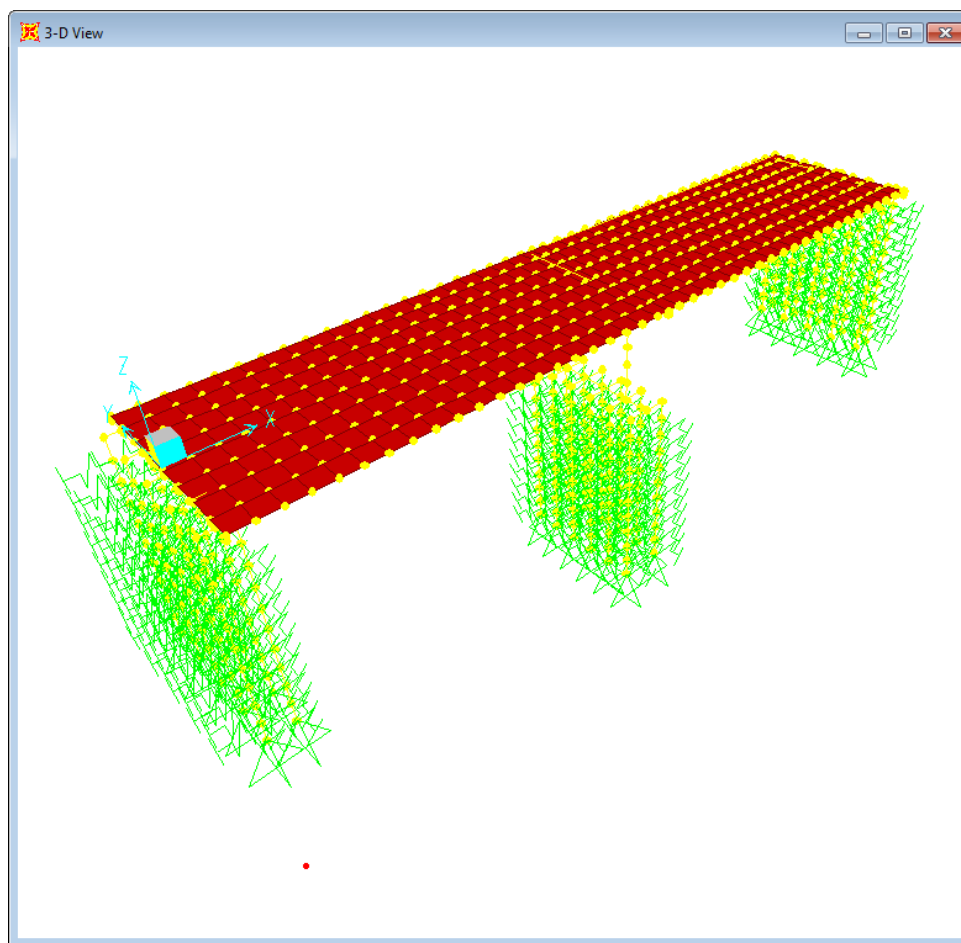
Modelo Tridimensional da Ponte – Superestrutura
